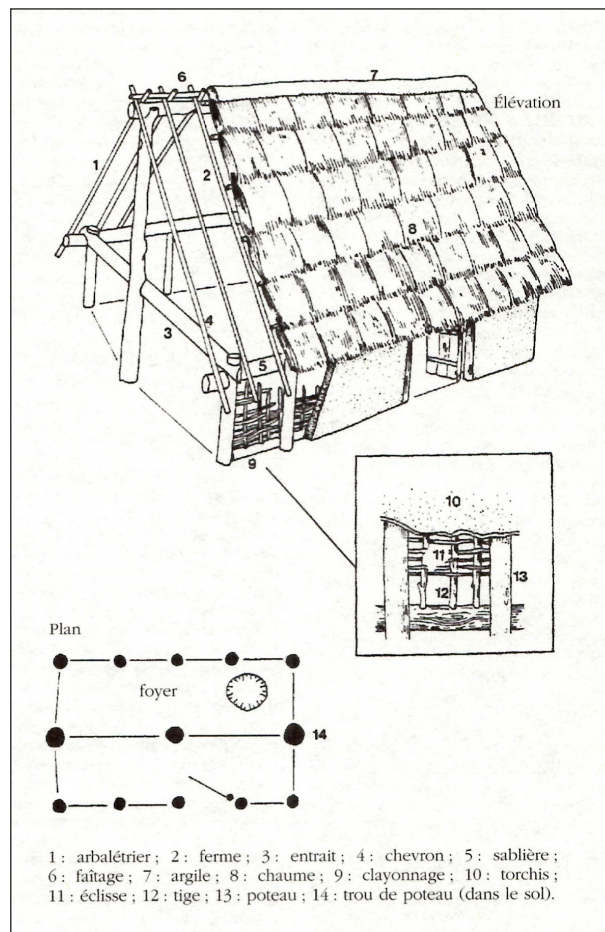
Exemple de restitution d'un bâtiment sur poteaux d'après le plan des vestiges archéologiques
